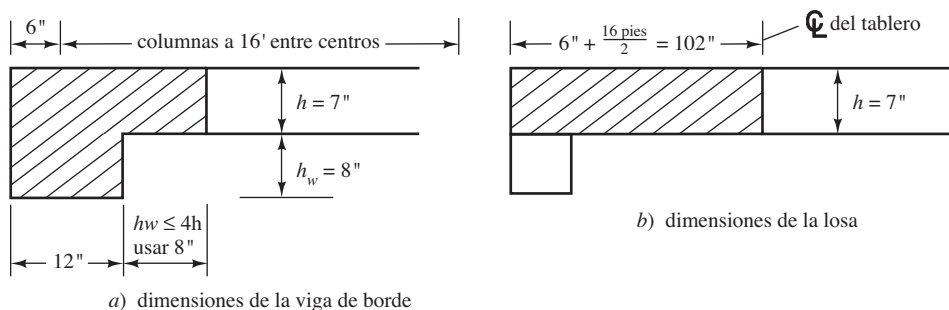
Secciones transversales de la viga de borde y de la losa.
